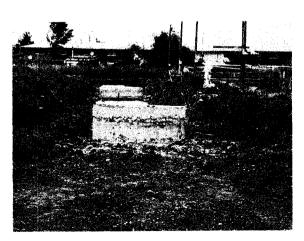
y 8, MINIMOS NIDOS DE PIEDRAS Y FIERROS A LA VISTA EN CADENAS
